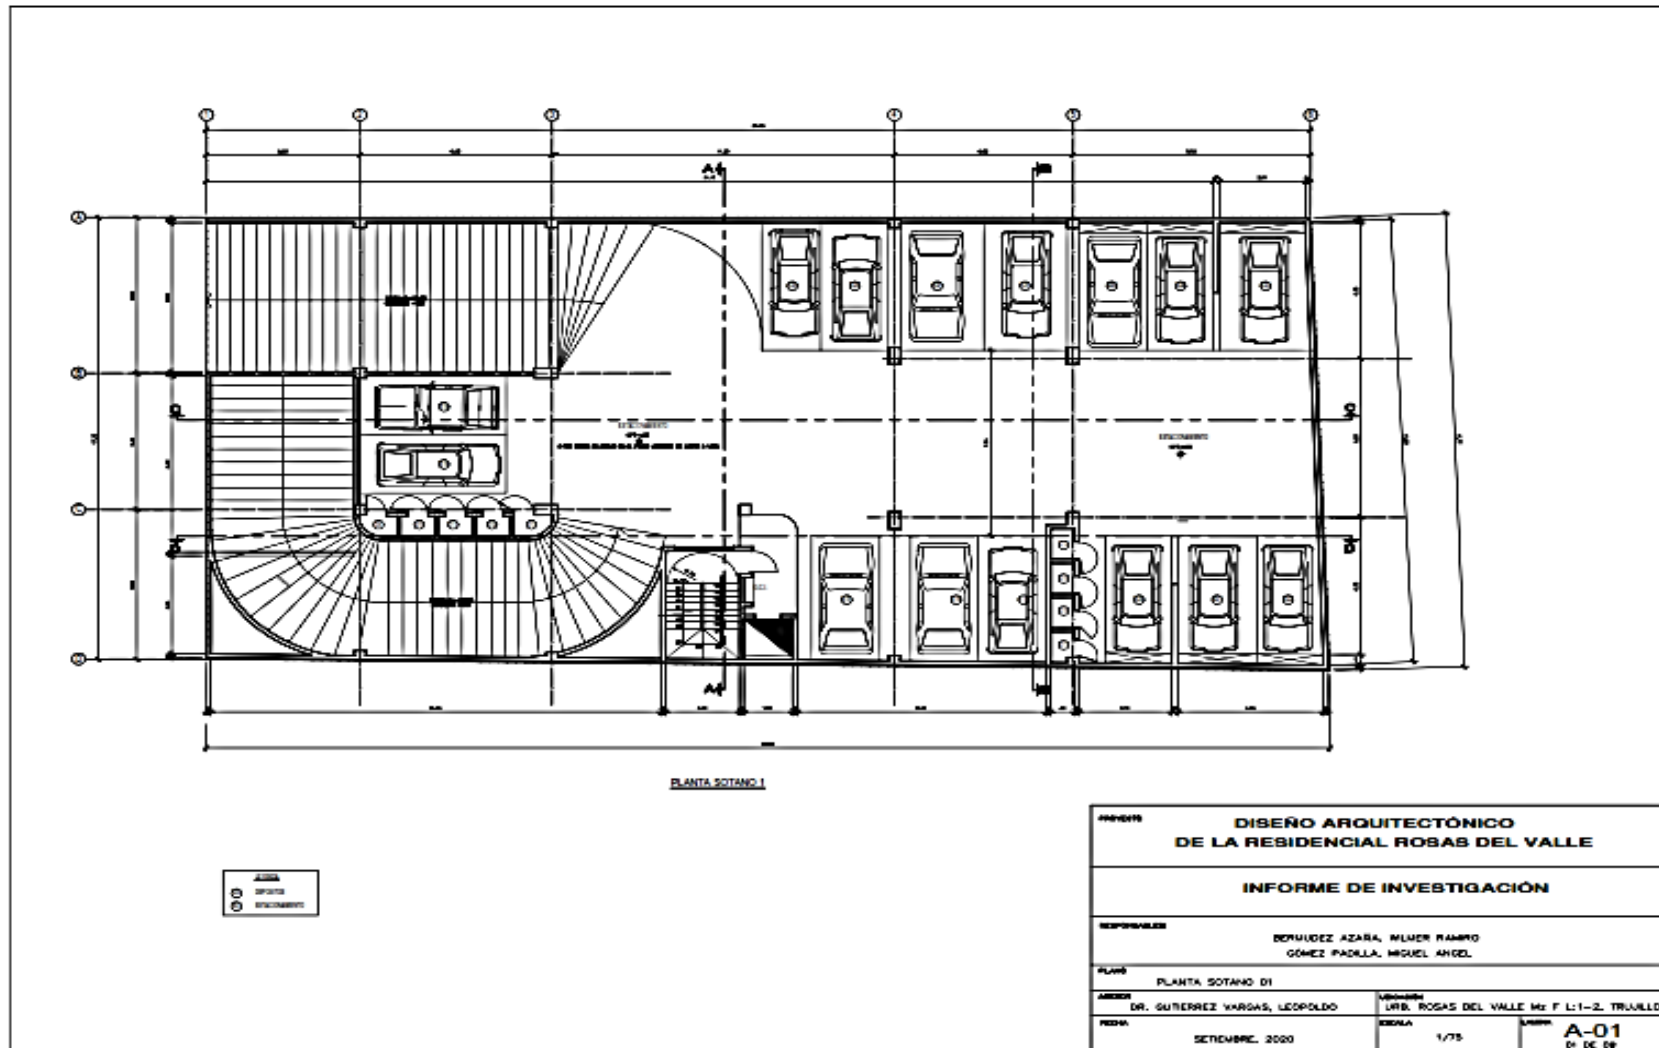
Plano de planta sótano 01 Fuente: Elaboración propia
